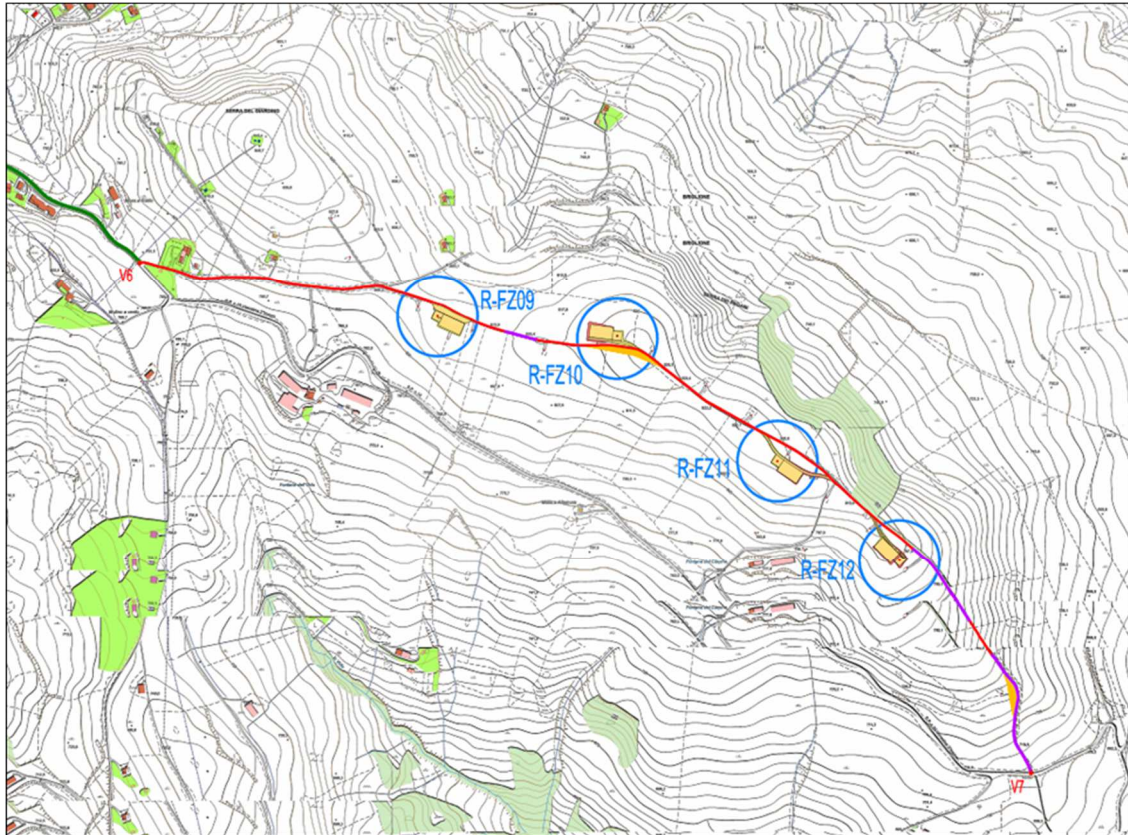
Stralci planimetrie d'impianto con viabilità di accesso agli aerogeneratori
